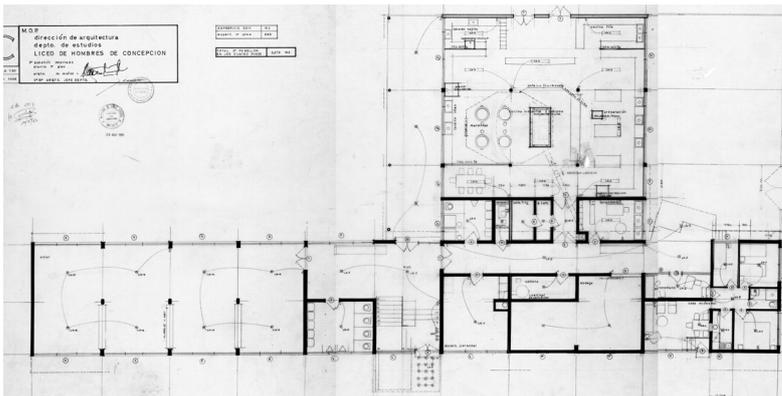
Esquema de planta 1er nivel. Fuente: Elaboración propia.
